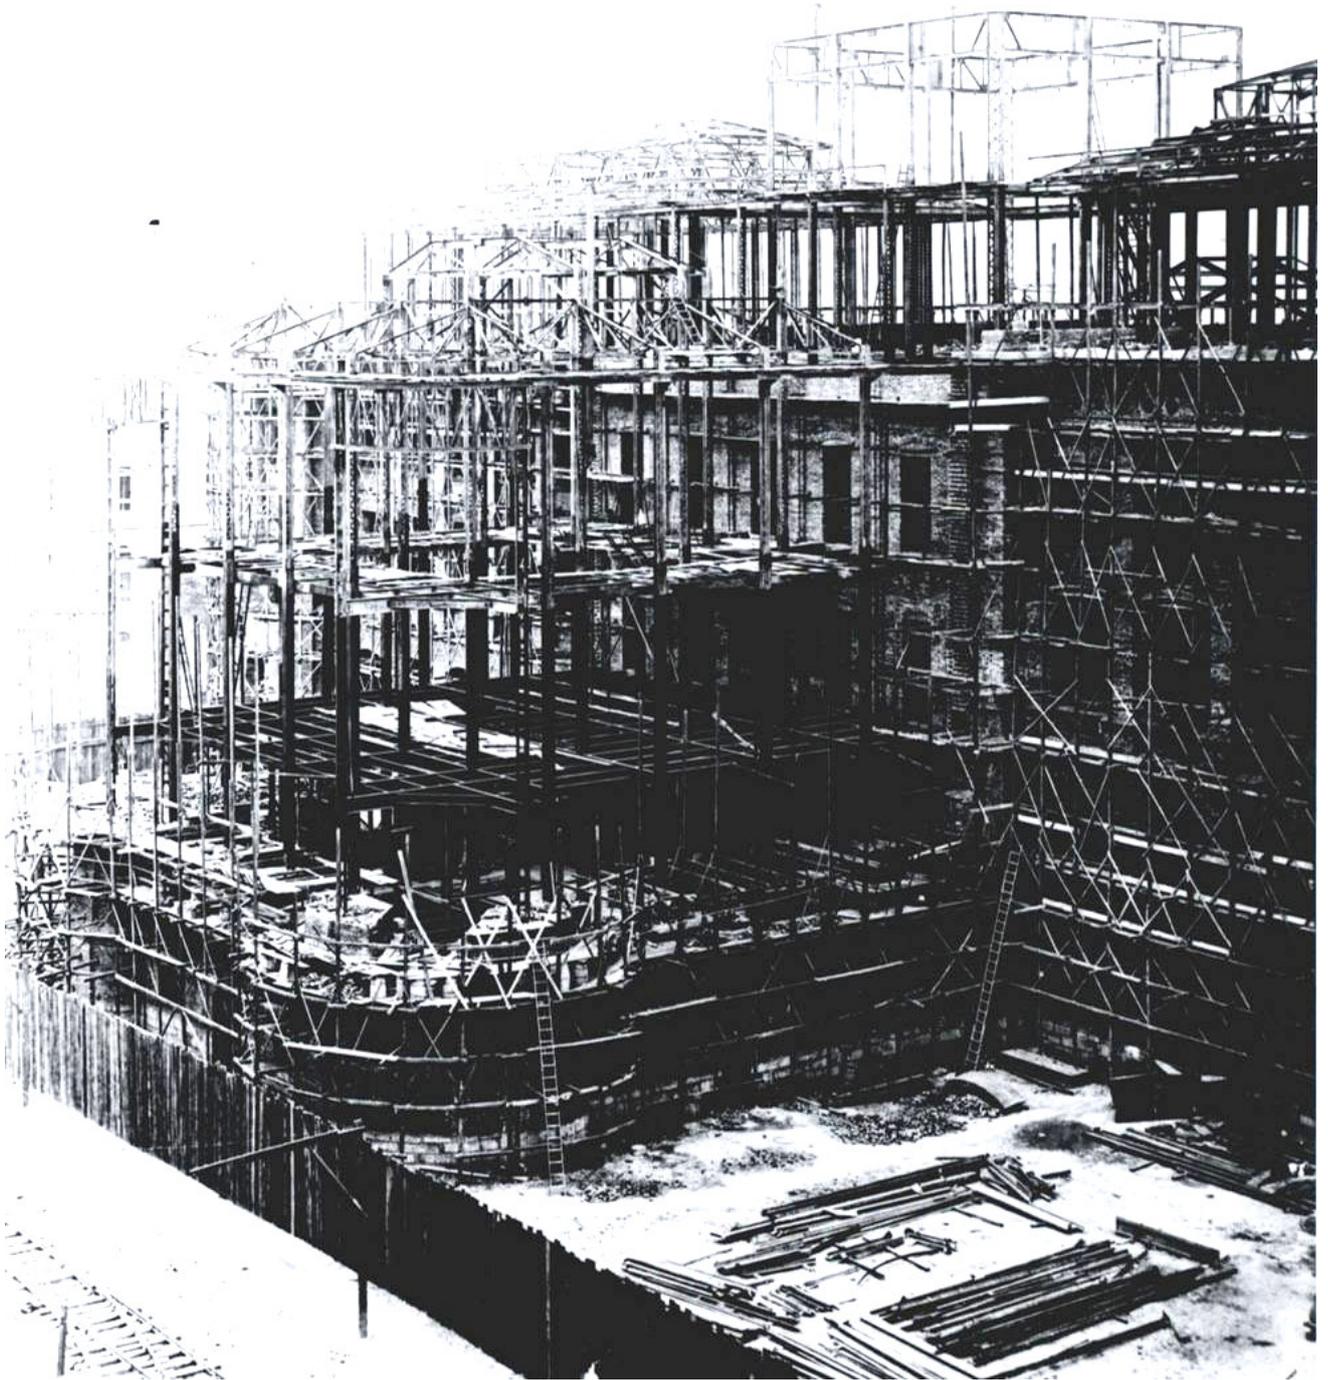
Fotografia da estrutura metálica Biblioteca Nacional em meio a sua montagem, podendo ser observada a estrutura dos cinco pavimentos do bloco central inteiramente montada e as alvenarias de vedação já em meio a execução, enquanto a estrutura da ala posterior ainda está sendo montada. (Álbum da Construção, sem data, cerca de 1906/1907. Seção de Iconografia – FBN).
